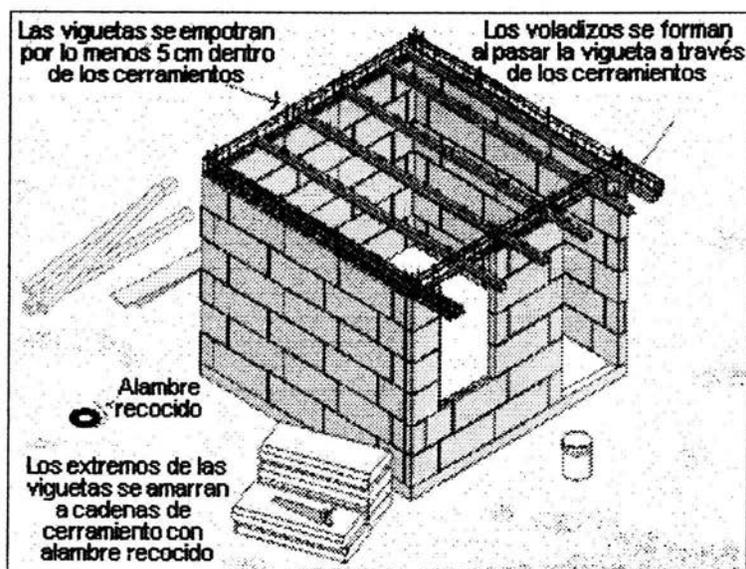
En la figura se muestra en forma esquemática el montaje de viguetas para sistema de entepiso de vigueta y bovedilla.
